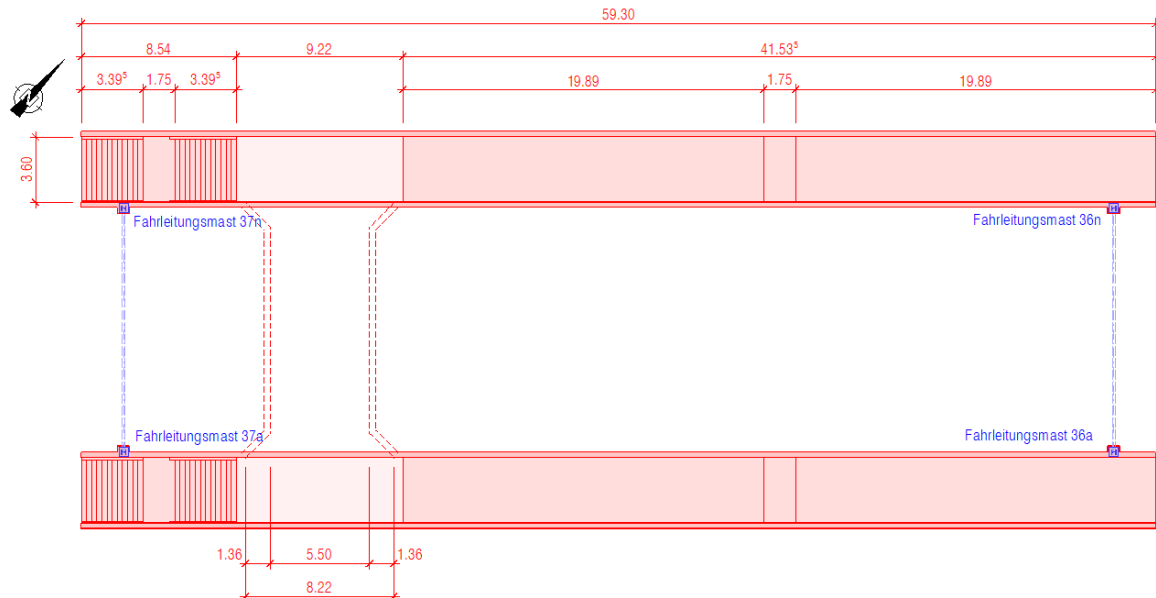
Grundriss Personenunterführung + Aufgänge + Fahrleitungsmasten
